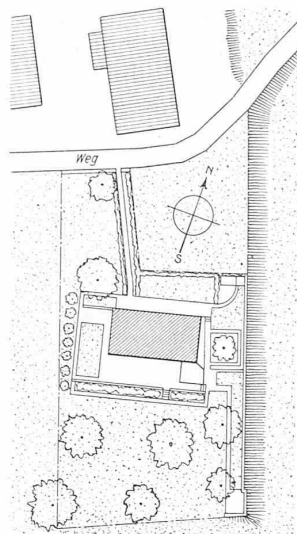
Lageplan 1:1000 des Wohnhauses von Architekt Max Kopp in Kilchberg bei Zürich.
